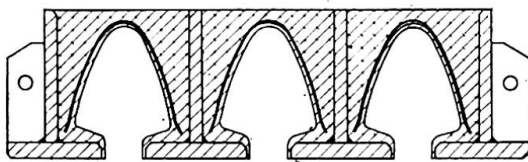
Querschnitt eines dreiteiligen Elementes.
